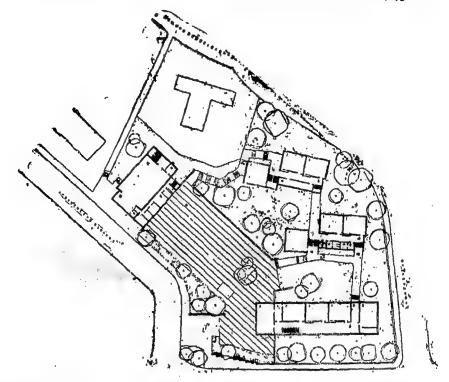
٢٧ - ٦ : مسقط افقى للدور الأرضى.
